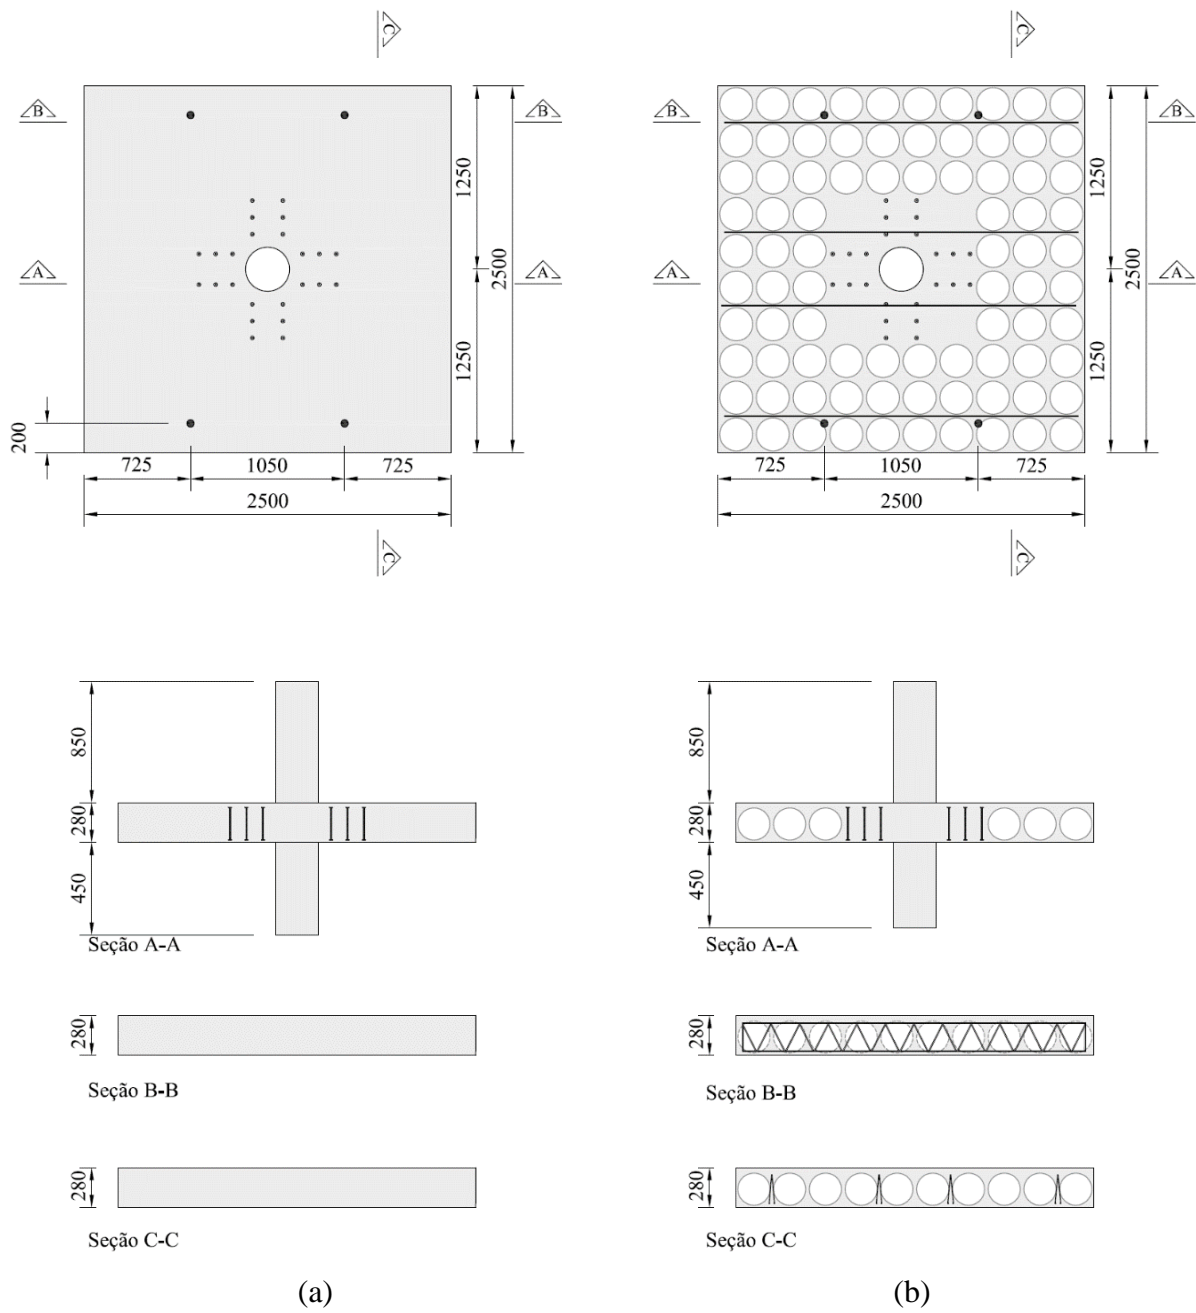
Planta e cortes das lajes (a) RSP-A01 (b) BD-A01.
